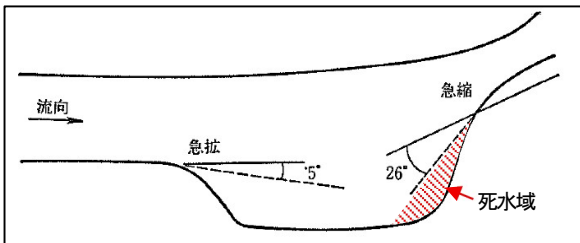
急拡・急縮部の死水域除去方法 (平面図) 1)
